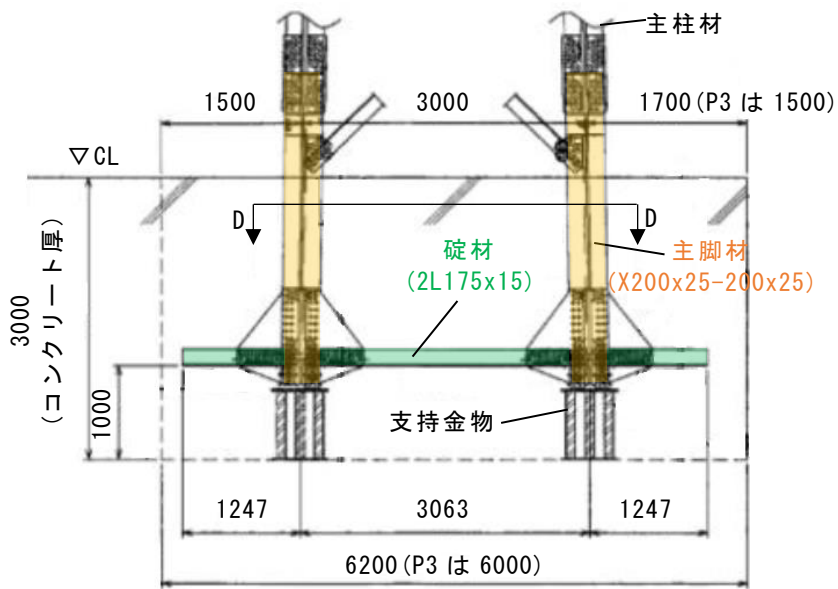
基礎コンクリート内の主脚材及び礎材の平面配置図
